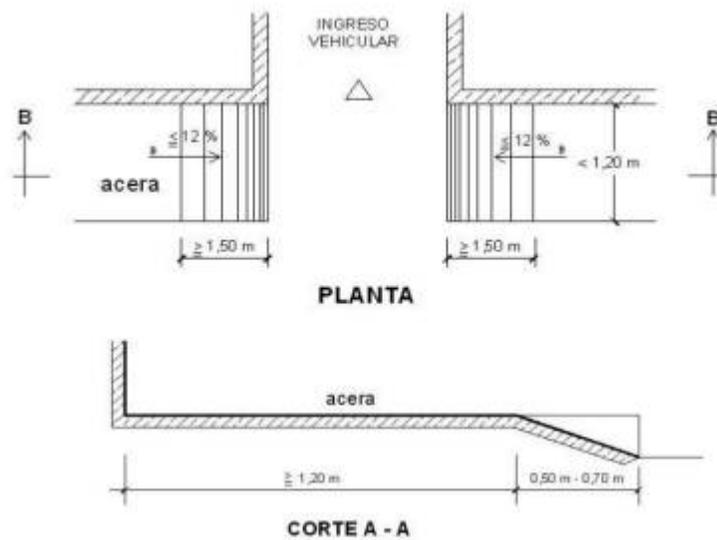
Rampas de accesos vehiculares longitudinales a la acera en caso de que su ancho sea menor a 1,20 m
